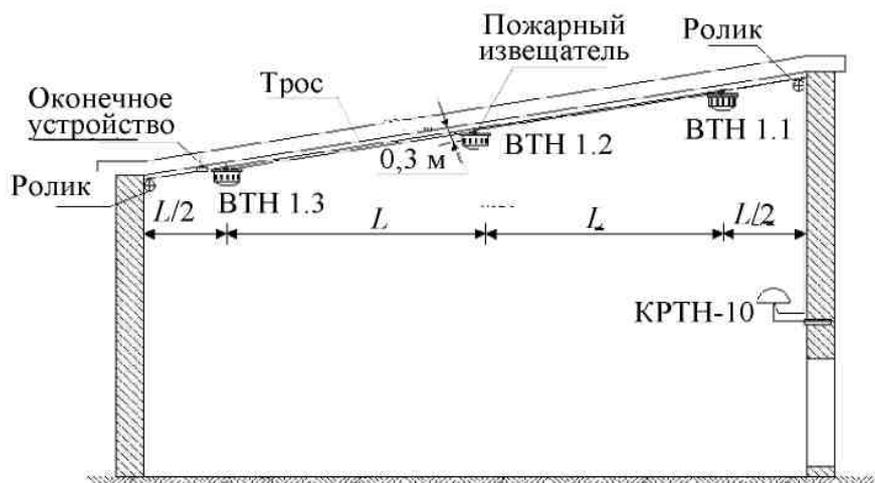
Вариант схемы размещения АПИ на тросах под перекрытием здания
